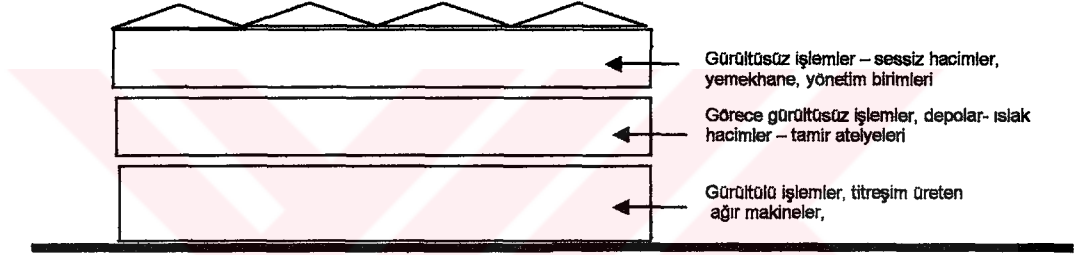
Üretim hacimlerinin birbirinden ayrılmasında tampon hacimlerden yararlanılmasına bir örnek.
